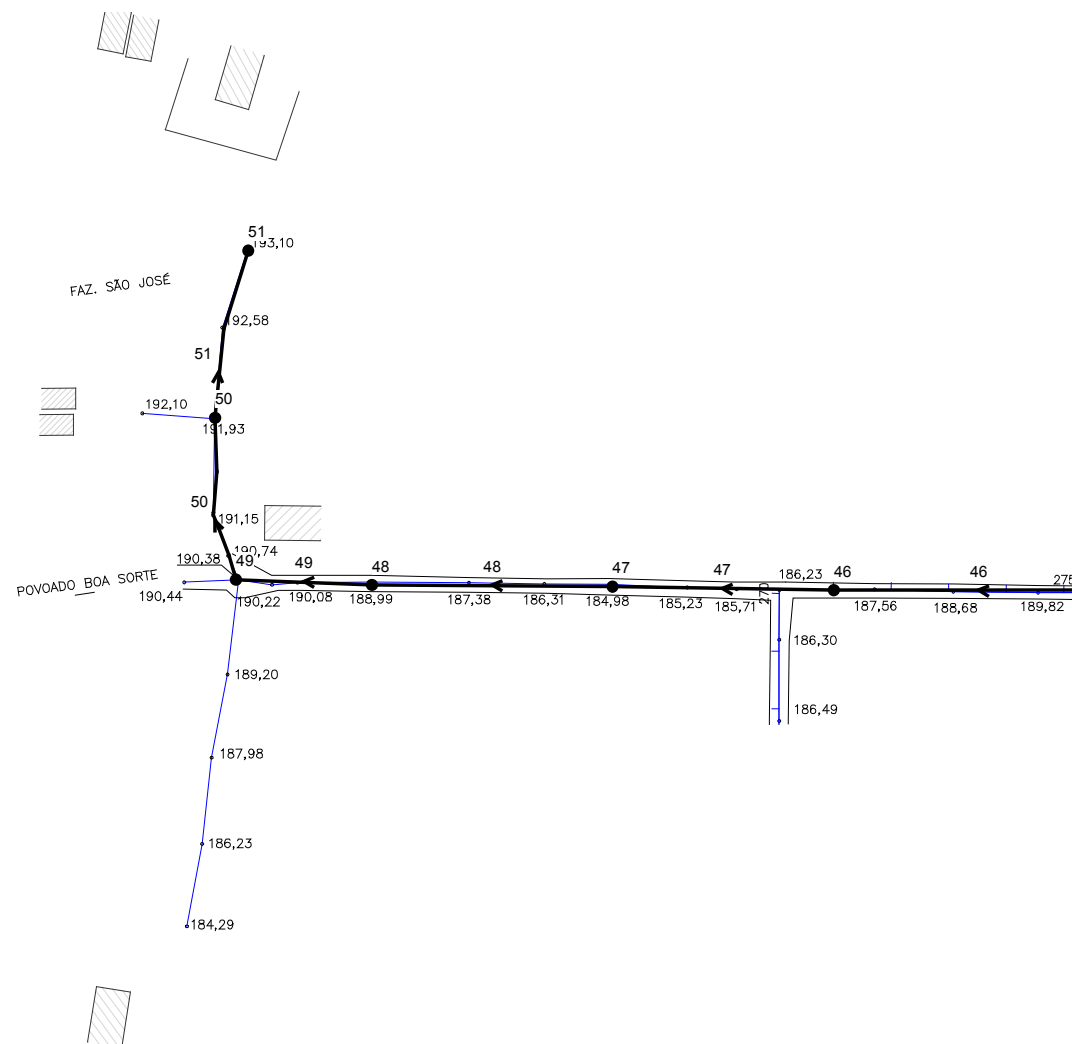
EPANET parcial 7 – Rede de Lajes 1
